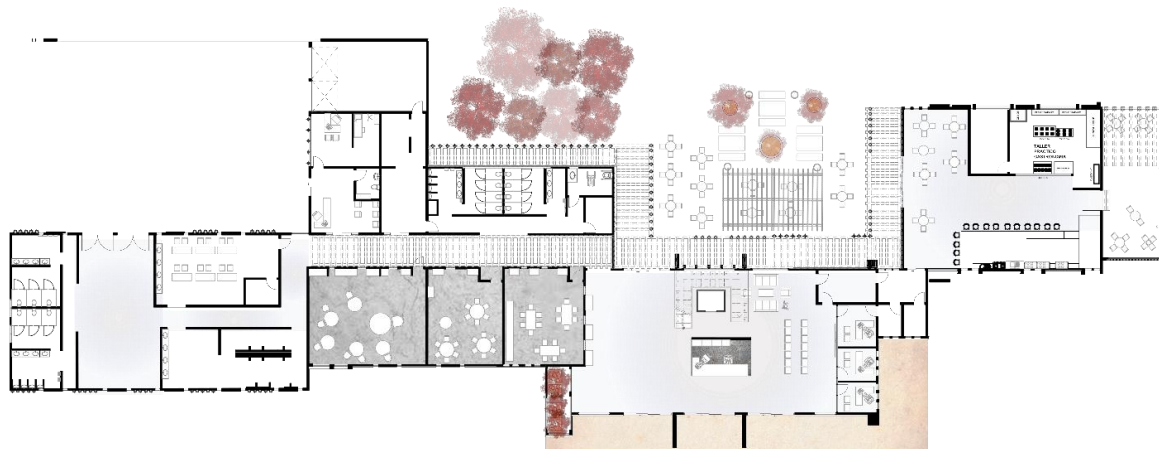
Planta Arquitectónica primer piso centro cultural municipal Fuente: propia
